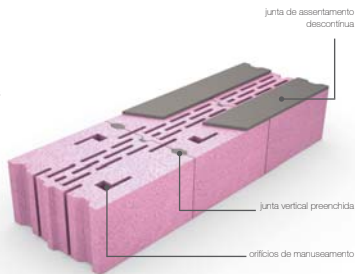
Pormenor das juntas horizontal e vertical numa parede exterior Conforto®
